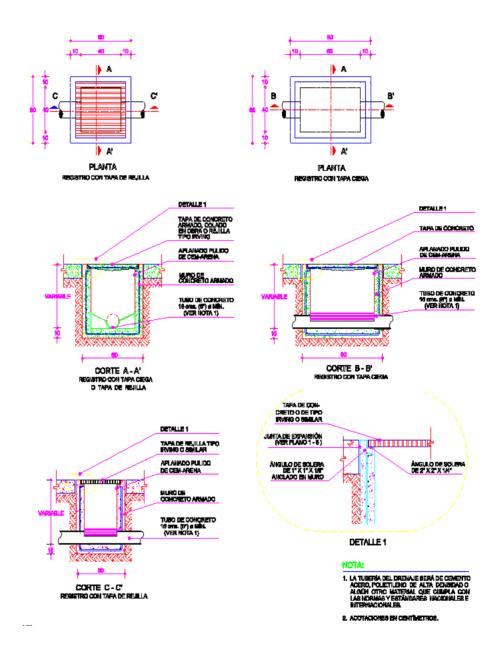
Detalle típico para instalación de drenaje aceitoso.
